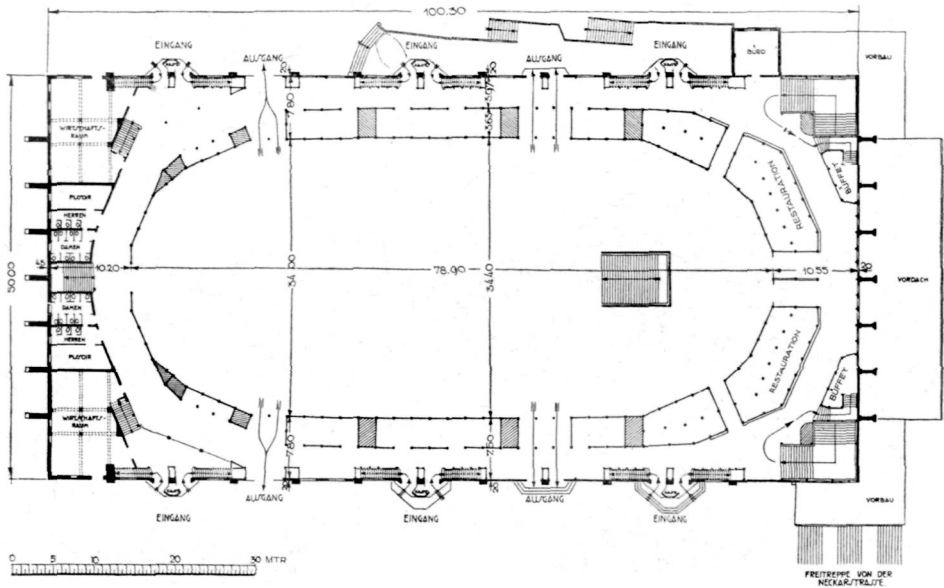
Sporthalle Stuttgart. Erdgeschoß-Grundriß
